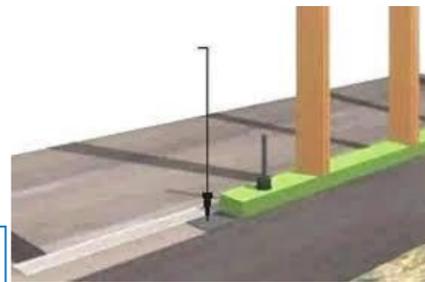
Fijación de Paneles estructurales con pernos de acero inoxidable. Fuente; Hector Scerbo. Estructuras en madera
